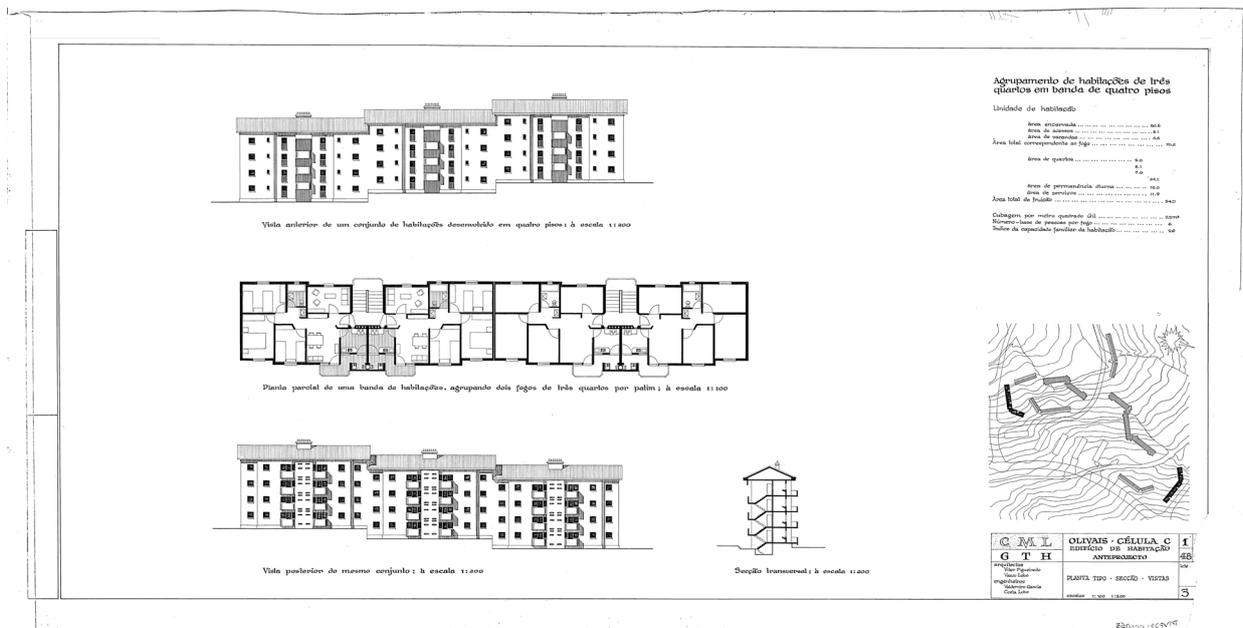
Anteprojecto: T3 - planta tipo, secções e vistas
